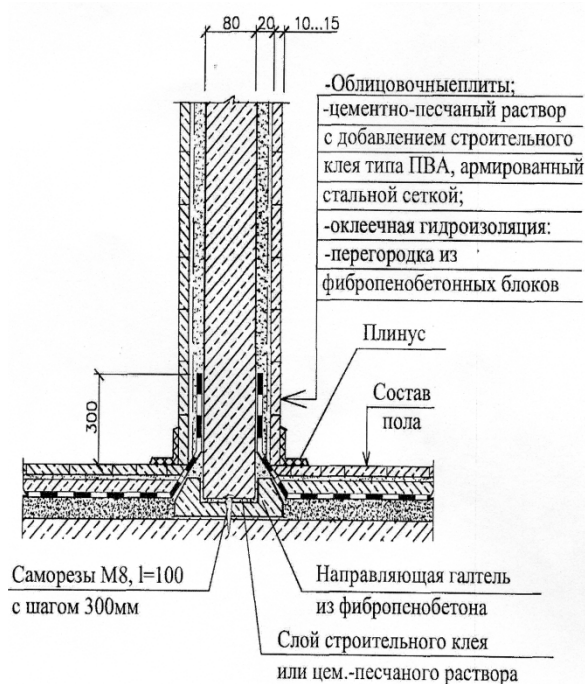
Схема перегородки из фибропенобетона для влажных помещений
